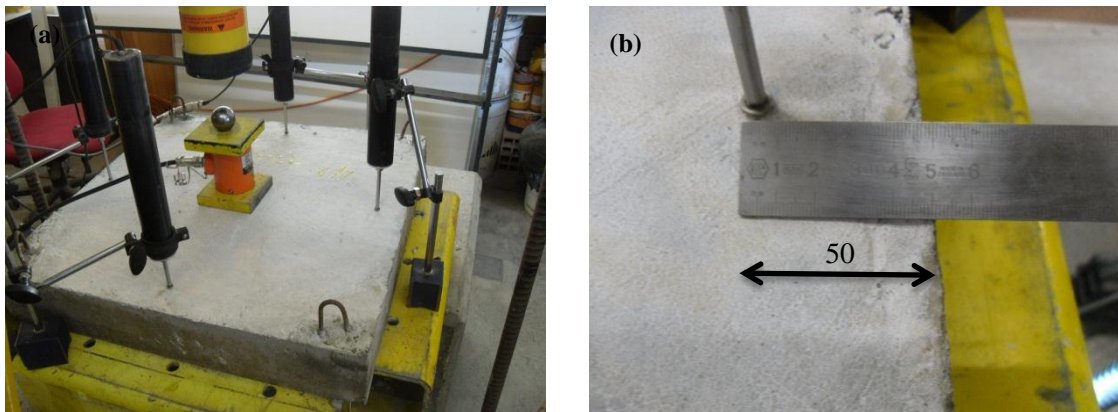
Disposição dos deflectómetros nos apoios, (a) vista geral dos deflectómetros sobre os apoios e (b) pormenor do deflectómetro sobre o apoio (dimensões em mm).
